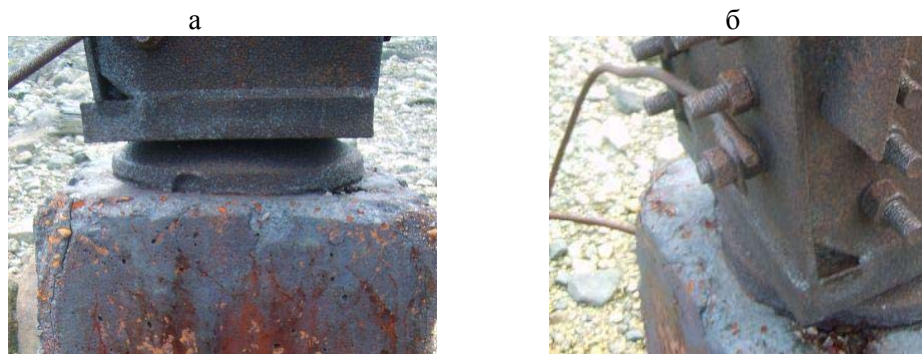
Дефекты фундаментов опоры и заземляющего спуска № 8 линии Л-153/154
